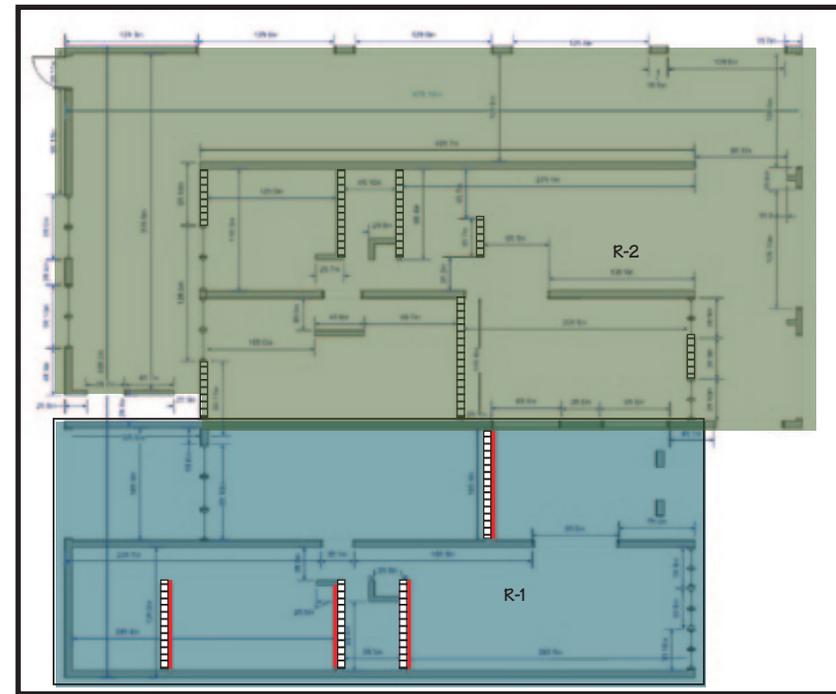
Diagrama de Planta de Estructura a ser Reforzada
